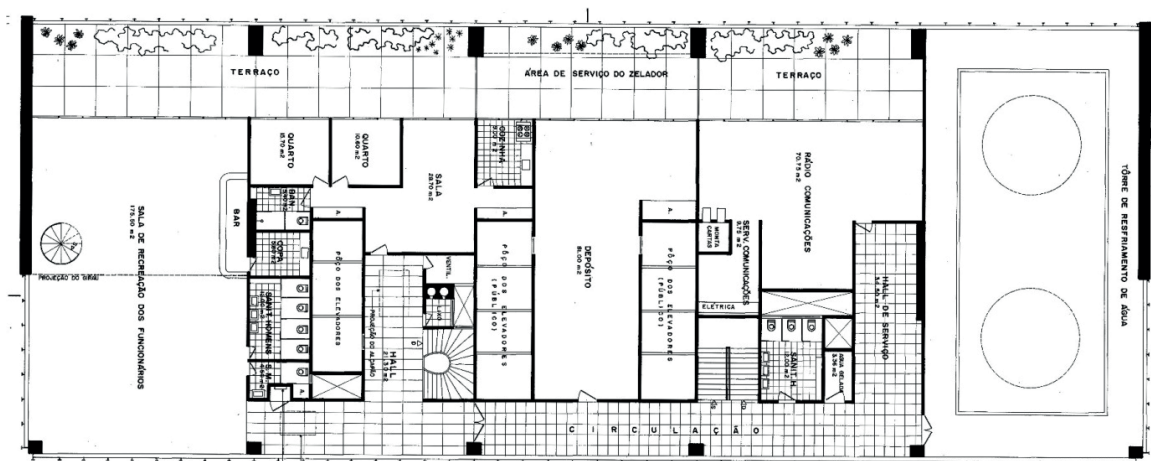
Planta do 22º andar mostrando o terraço que avança pela fachada leste do Sede I. Fonte: Arquivo digital nosso sobre desenho de Garcia Roza.
